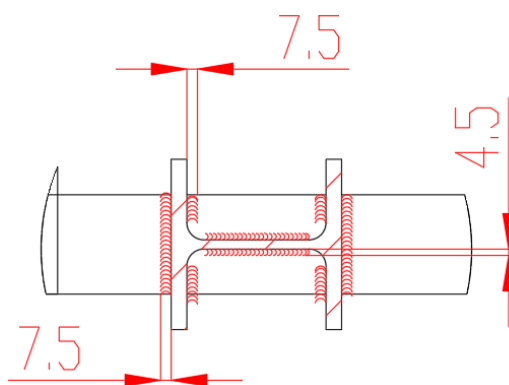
Unión pilar de apoyo HEB-120-viga UPN-180 escalera.
